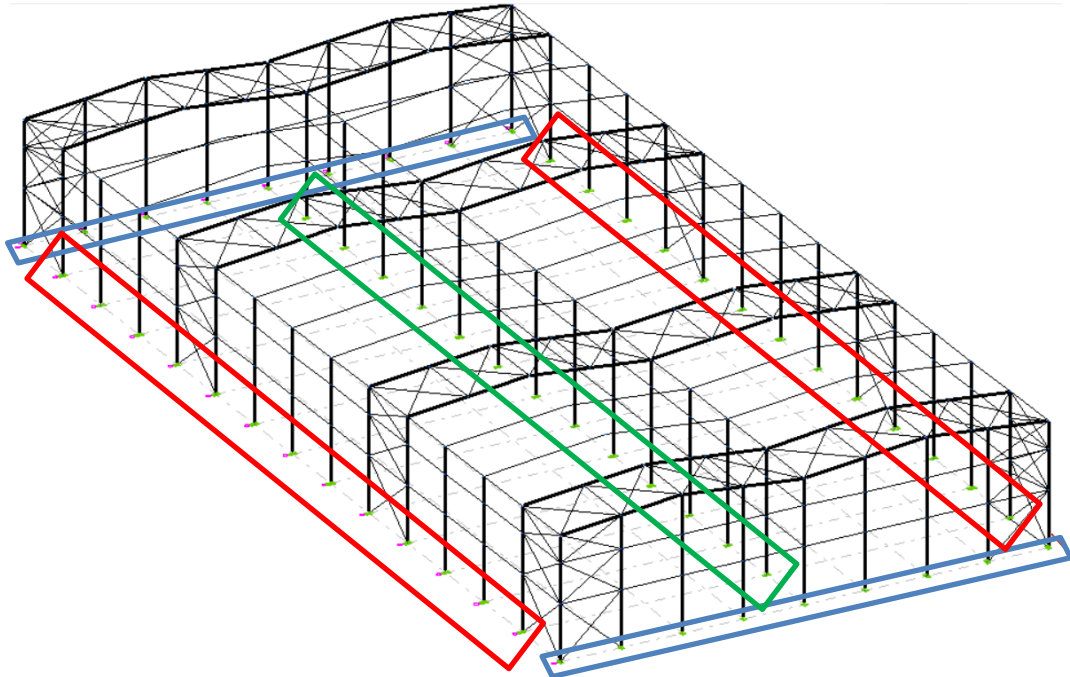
Tipos de placas de anclaje empleadas. Azul: Tipo 1. Rojo: Tipo 2. Verde: Tipo 3. Fuente: CYPE
